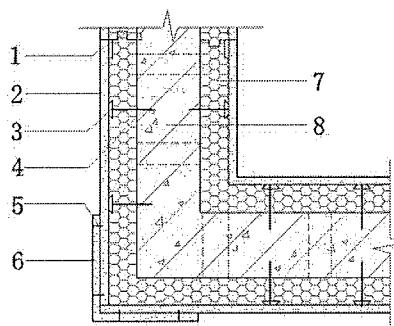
水泥板与墙体阳角连接组合构造（水平剖面）
